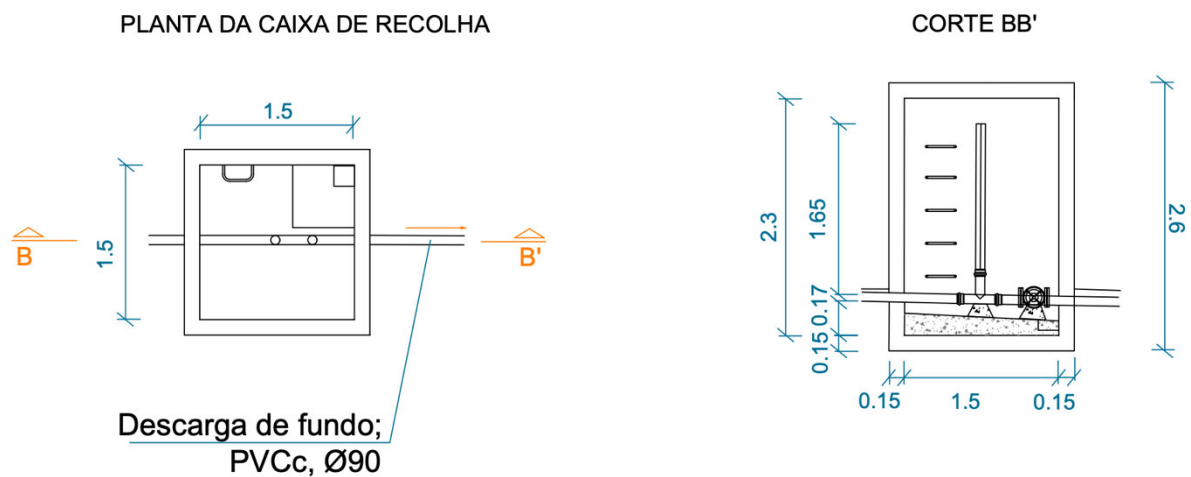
Planta e Corte BB' da caixa de recolha.
